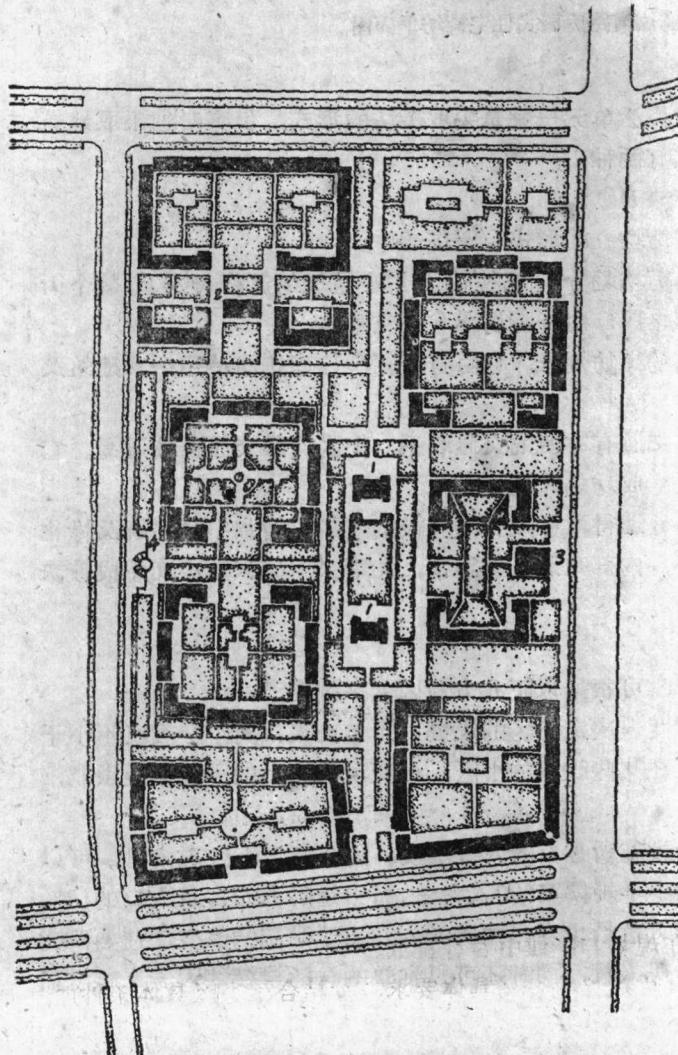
莫斯科西南区高层建筑街坊(8层)平面图
